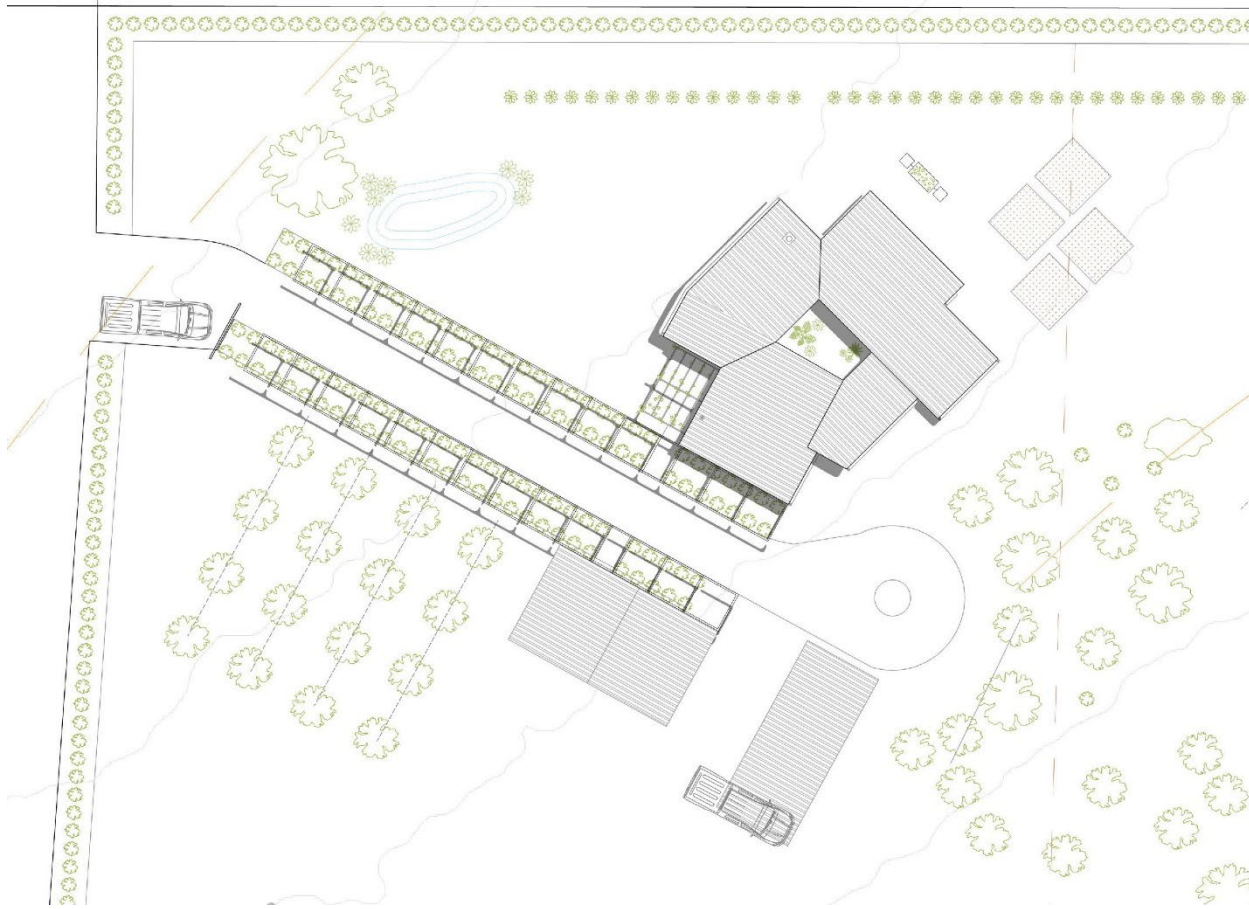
Planta de cubiertas y emplazamiento de la vivienda.
